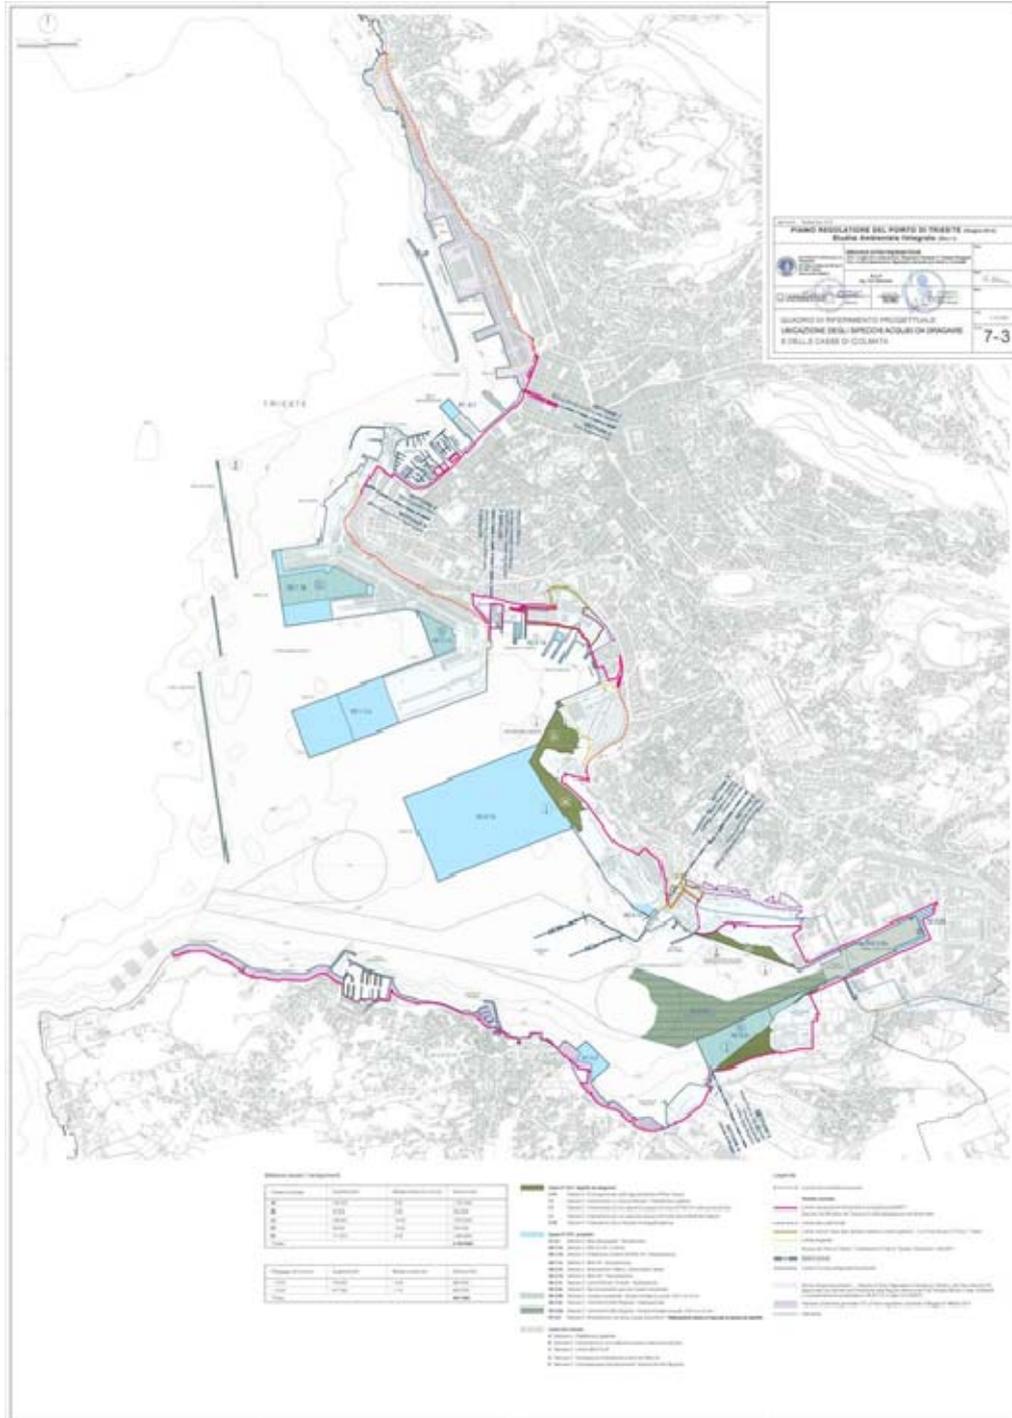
PLANIMETRIA GENERALE DEL PORTO DI TRIESTE
